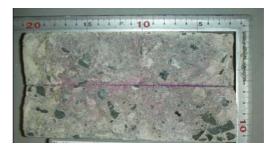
ひび割れ面の中性化 (case1-PL-5% 8 週)
